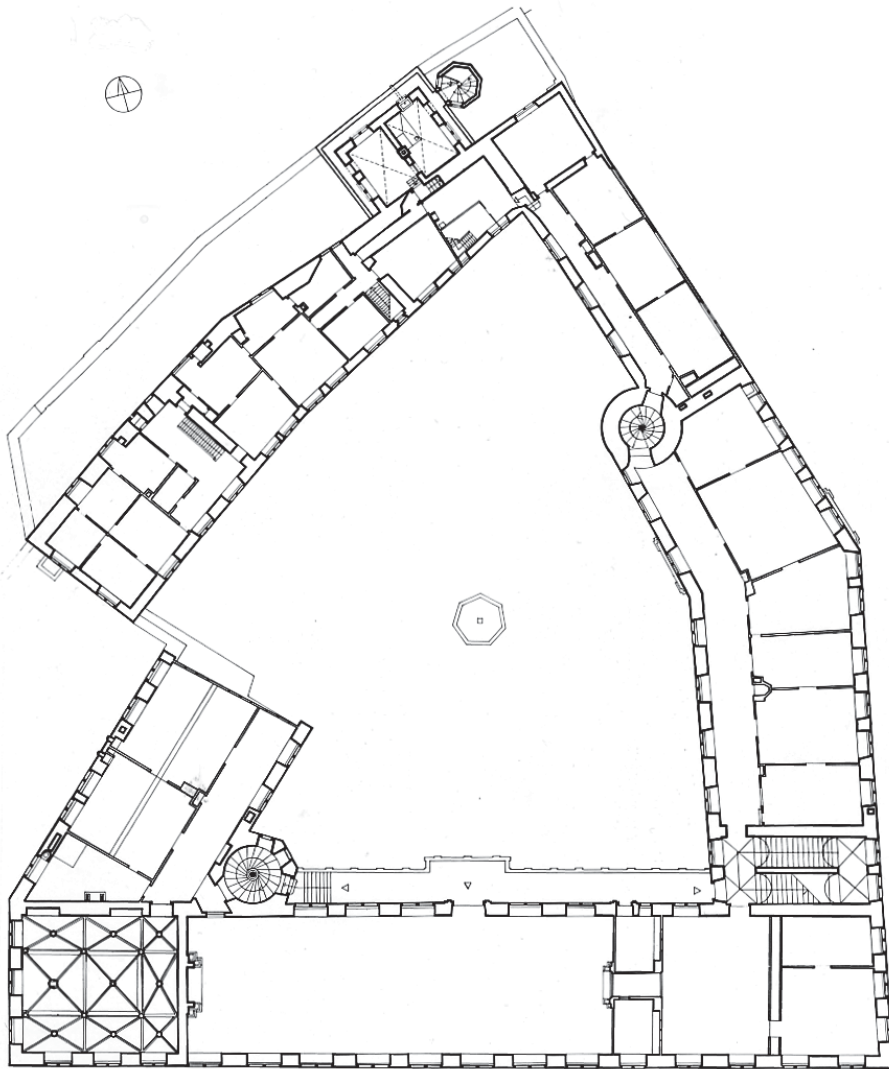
Schloss Weikersheim, Grundriss des 1. Stockwerks, Bauzustand um 1610 (Zeichnung: Walther-Gerd Fleck, Stuttgart)
